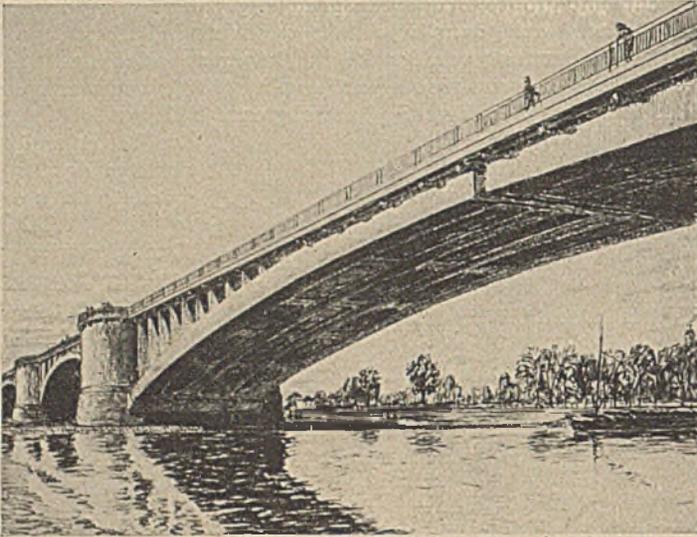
Entwurf Elbbrücke Dresden. Ansicht des Hauptbogens, Variante mit geschlossener Unterfläche.
